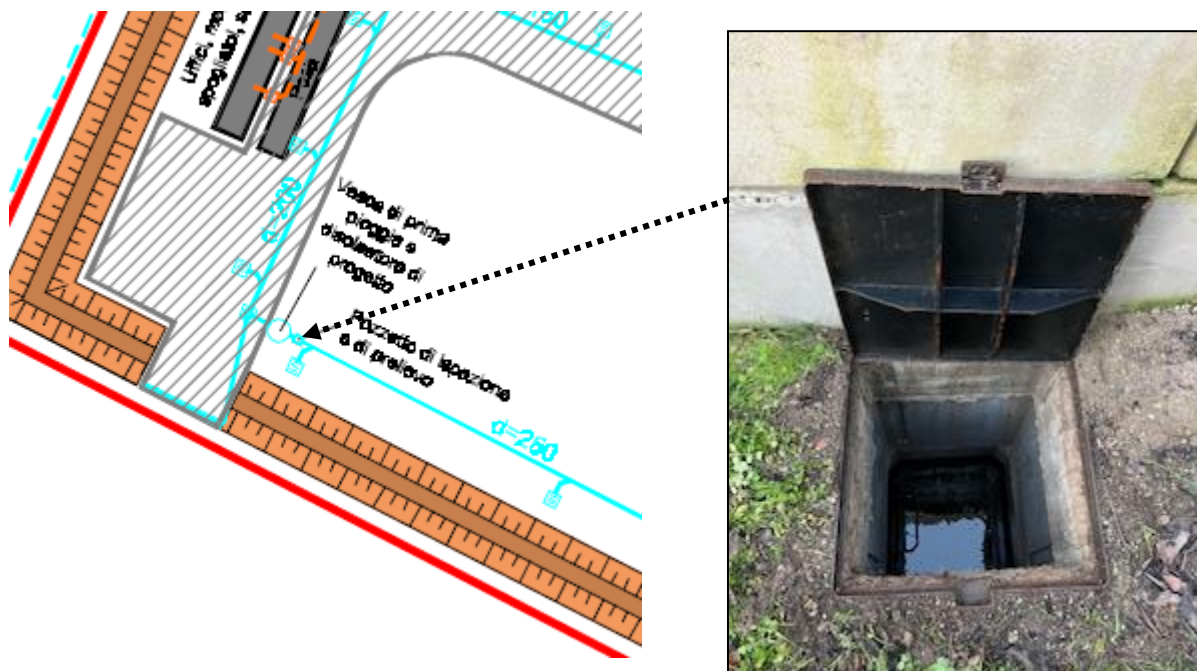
Pozzetto di ispezione in prossimità dell'ingresso dell'impianto
